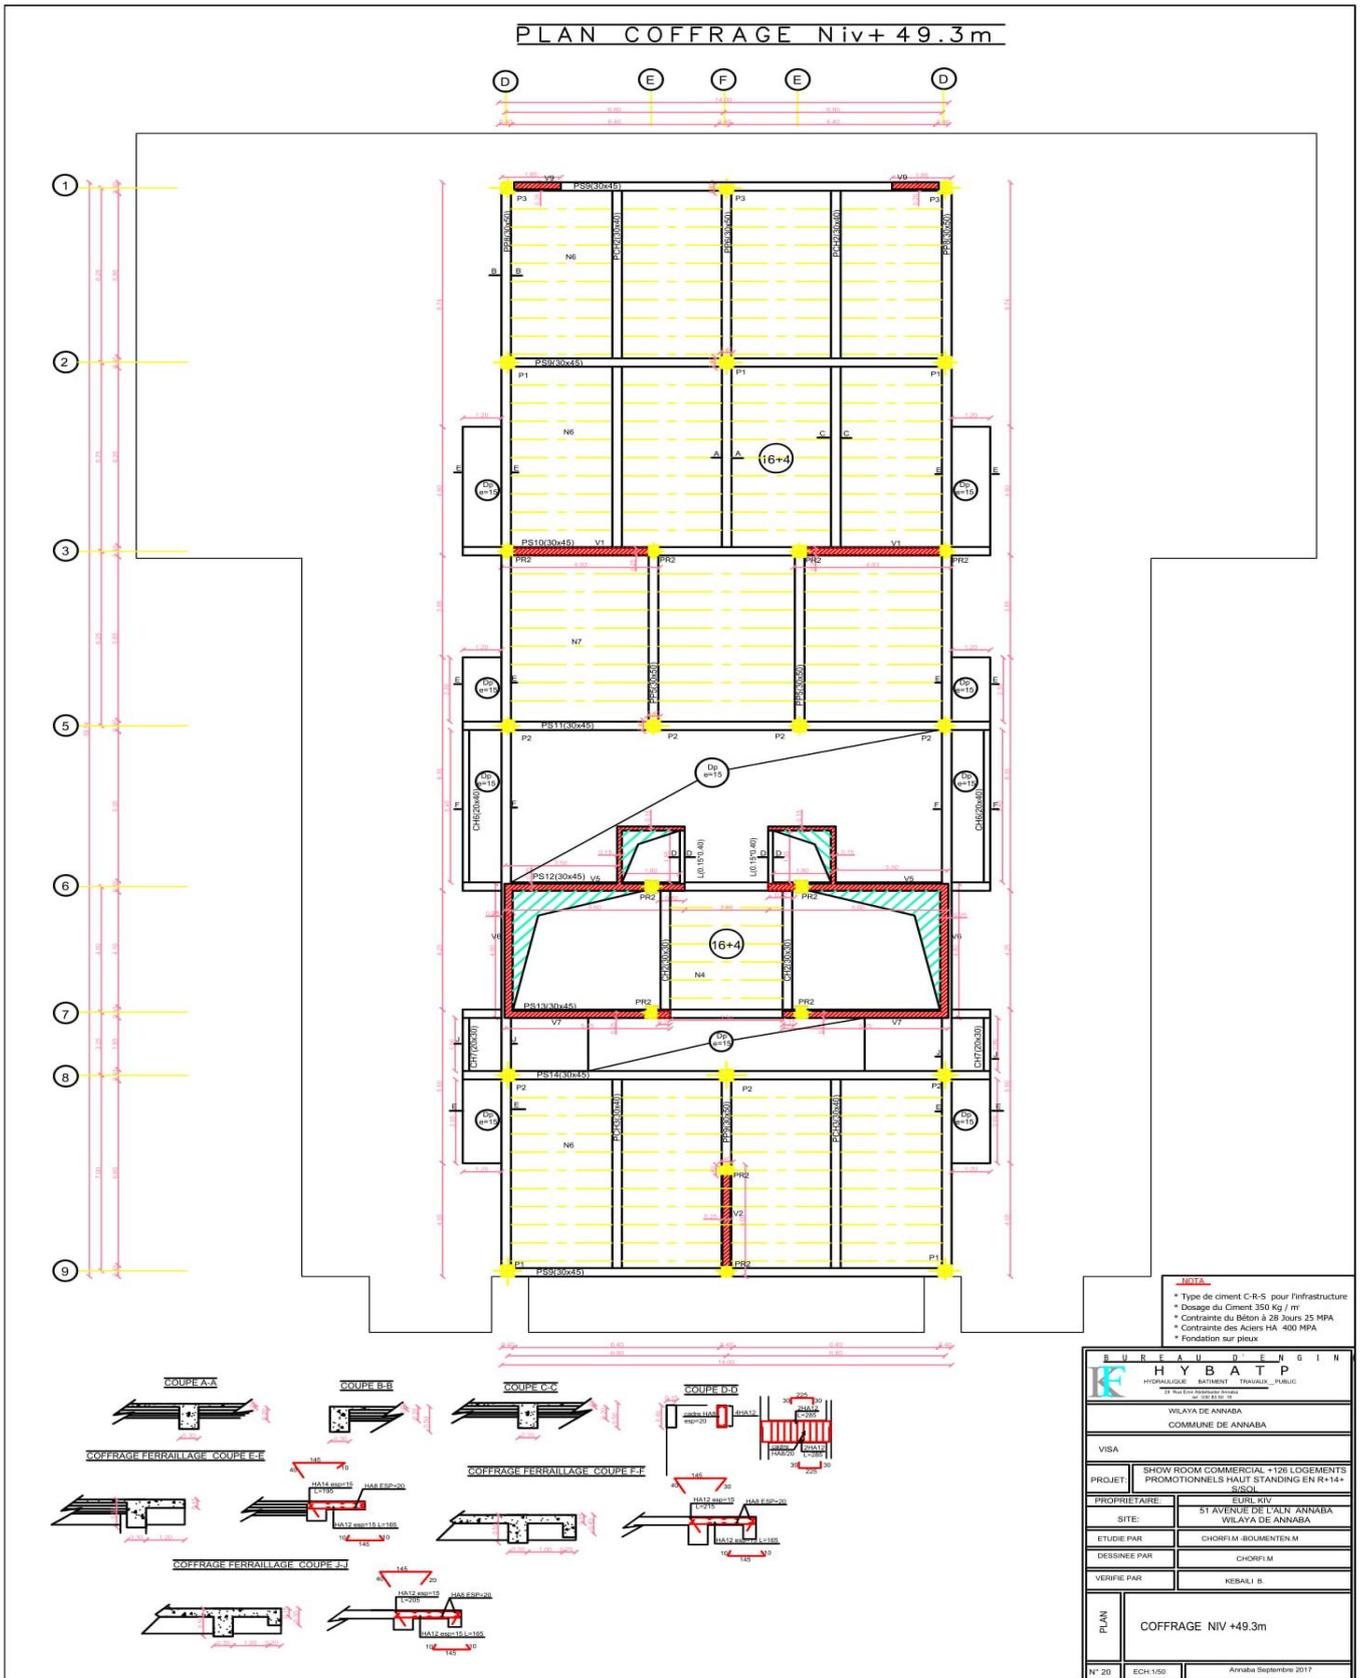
plan de coffrage NV +49.3m (duplex)
